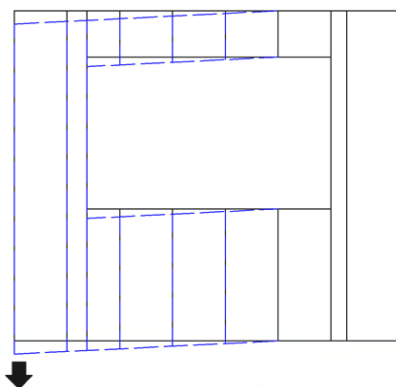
Esquema de deformaciones del muro lado sur de acuerdo con el levantamiento topográfico realizado a la estructura en su primera etapa. Se pueden observar los asentamientos diferenciales en el extremo del muro.
